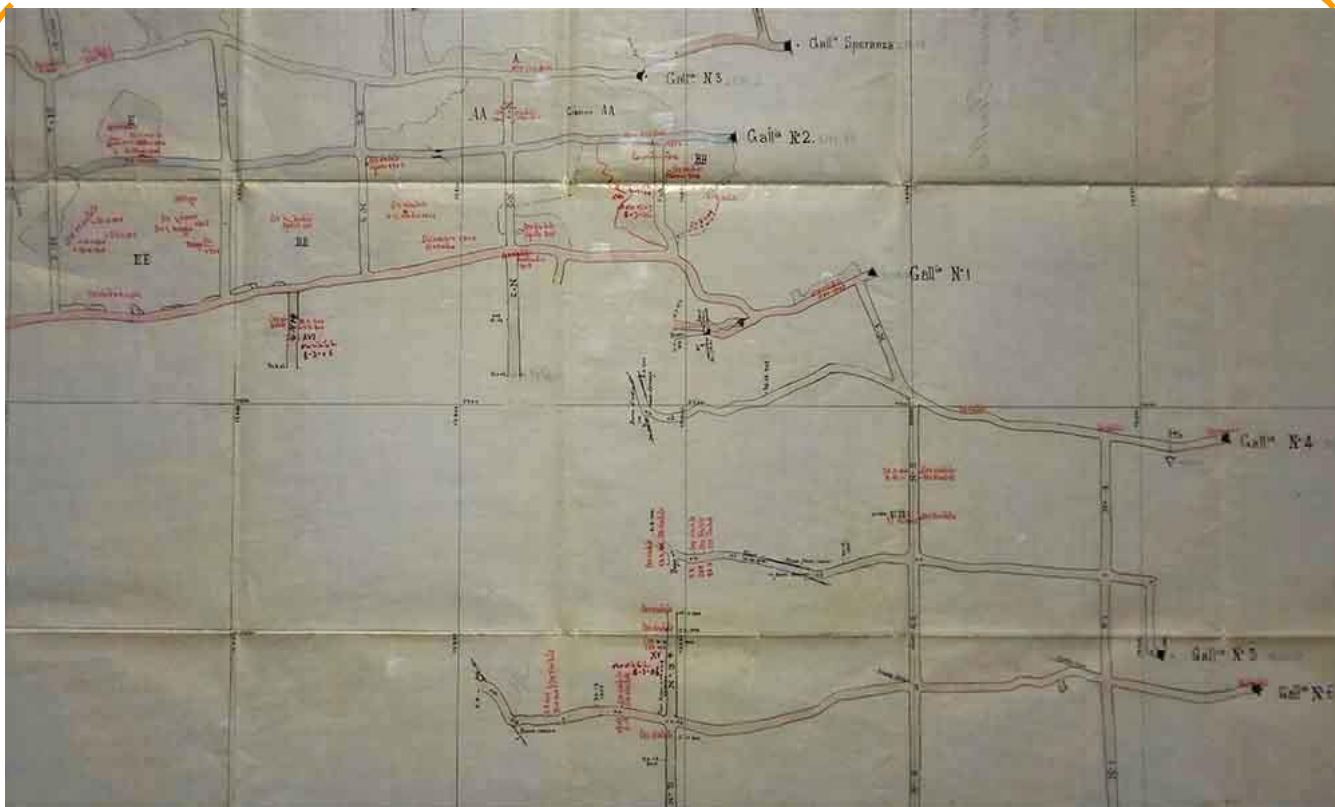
Miniera d'oro di Brusson: dettaglio della pianta; in alto a sinistra abbiamo il cantiere di coltivazione E (Miniera d'Oro Chamousira a Brusson).
